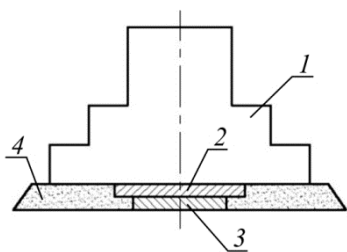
Схема устройства подготовки под фундамент из двух бетонных плит разных геометрических размеров в плане: 1 – фундамент под колонну; 2, 3 – бетонные плиты разных геометрических размеров в плане; 4 – песчаная подготовка по контуру плит
